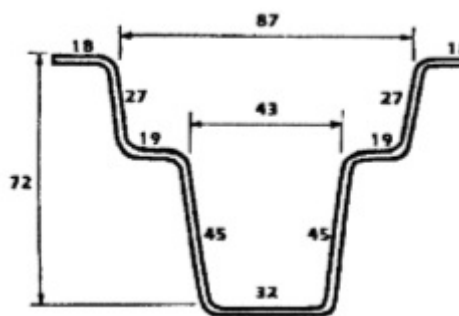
Exemplo de Fôrma para Laje Pré-moldada Tipo Trilho. (Lajes Nervuradas de Concreto armado: Projeto e Execução. BOCCHI JR, 2005.)
